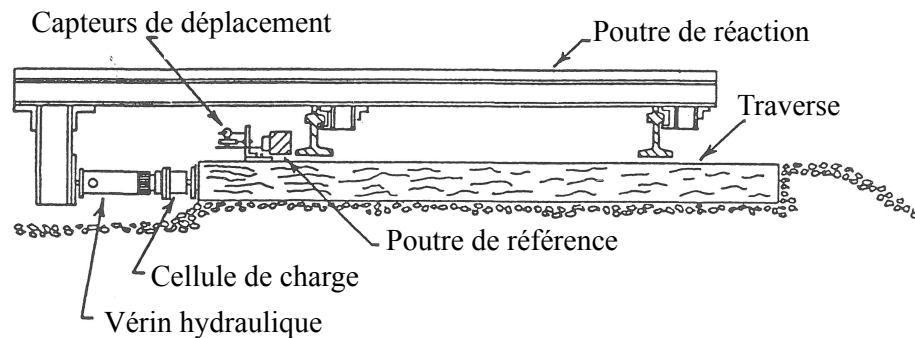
Essai de poussée latérale sur la traverse [Selig & Waters \(1994\)](#)
